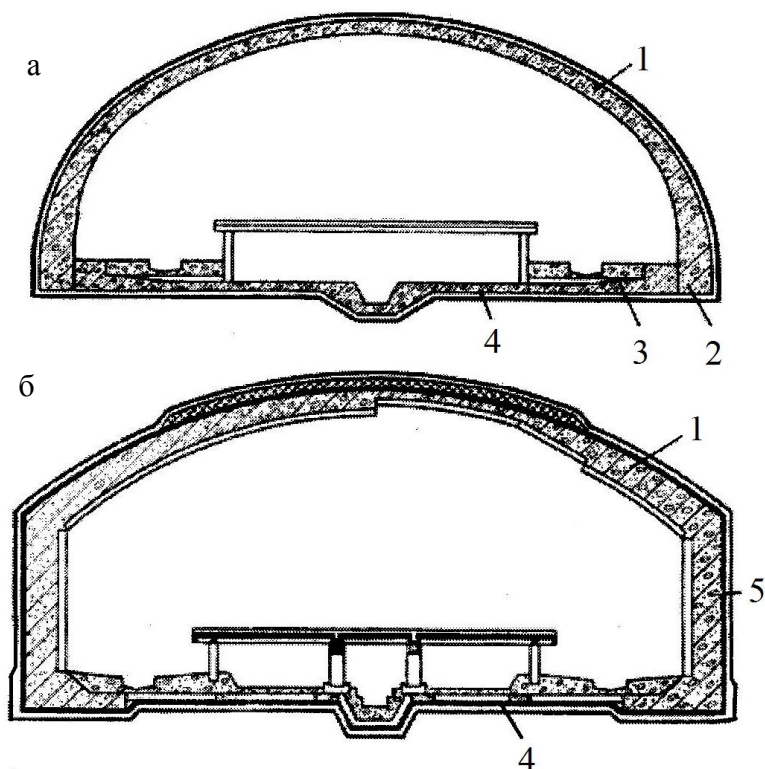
Поперечные сечения односводчатых станций: а – со сводом полуэллипсного очертания; б – со сводчатым ригелем и вертикальными стенами; 1 – свод; 2 – пята свода; 3 – плита-консоль; 4 – плита-лоток; 5 – боковая вертикальная стена
